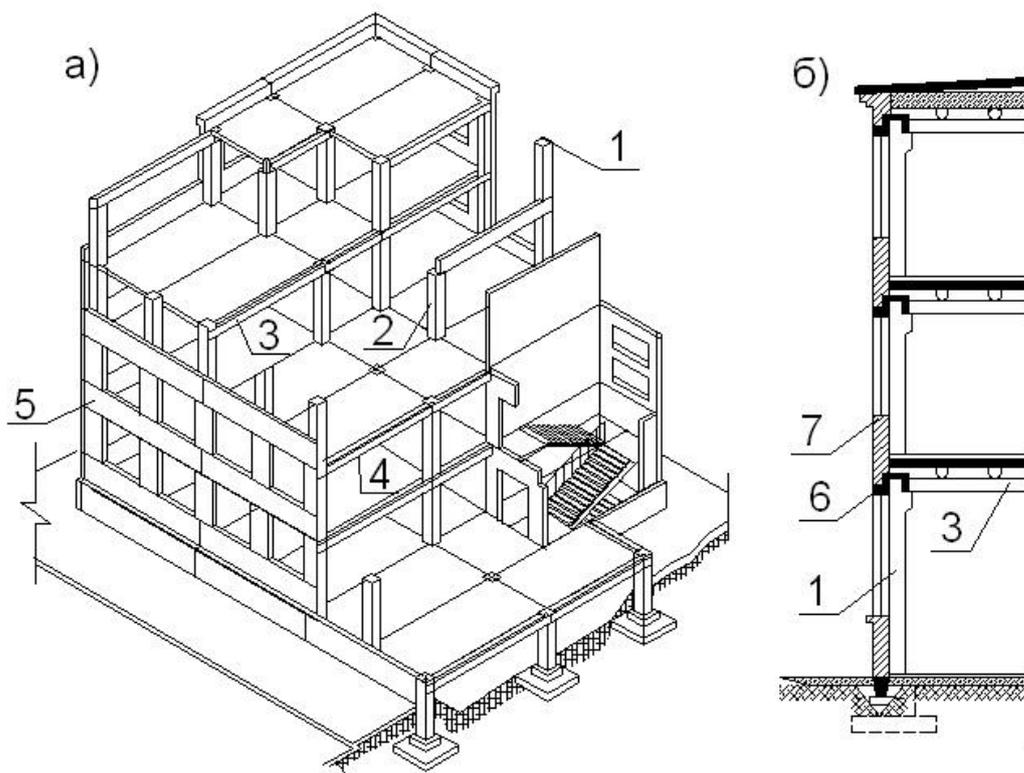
Каркасна будівля: а - загальна схема, б - деталі влаштування несучої стіни; 1 - стійки (колони) зовнішнього ряду; 2 - внутрішні стійки (колони); 3 - ригель каркаса (прогін); 4 - панелі перекриття; 5 - самонесуча стіна; 6 - бортова балка; 7 - не несуча стіна.
